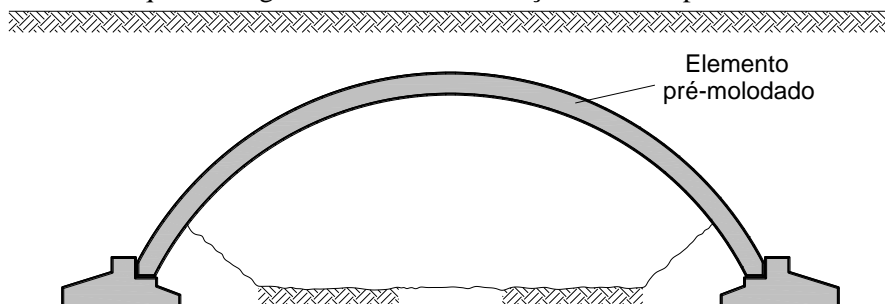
Outras alternativas com seção transversal fechada formada por segmentos
